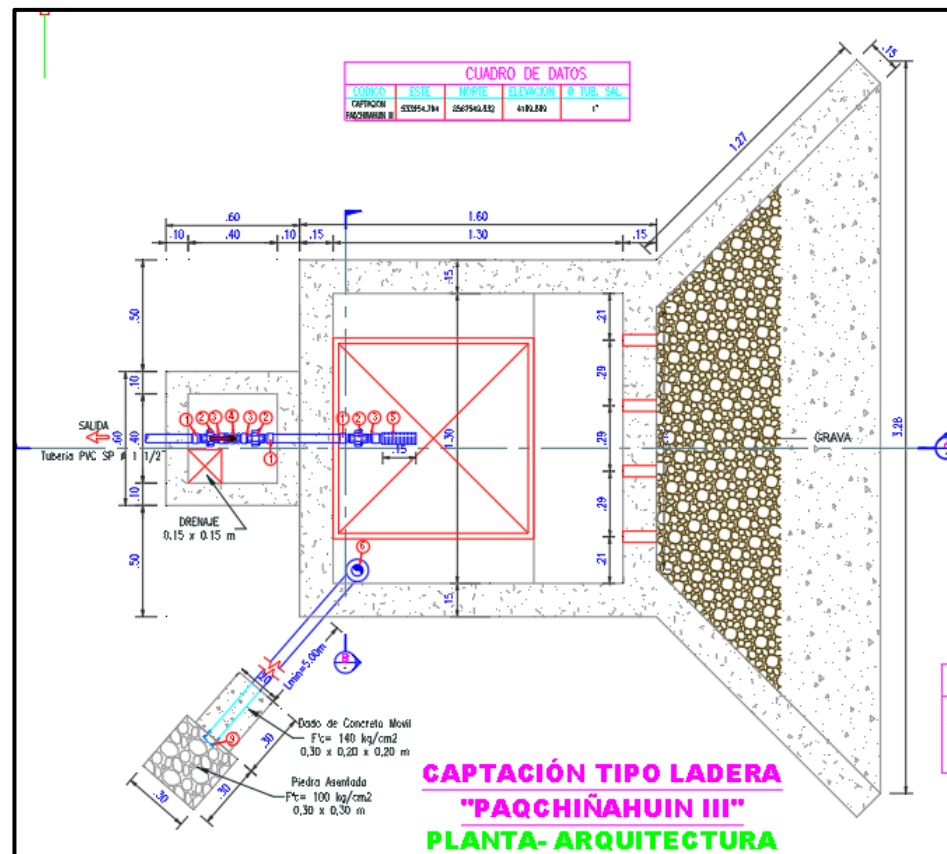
Planteamiento de Captación Tipo Ladera en Planta
